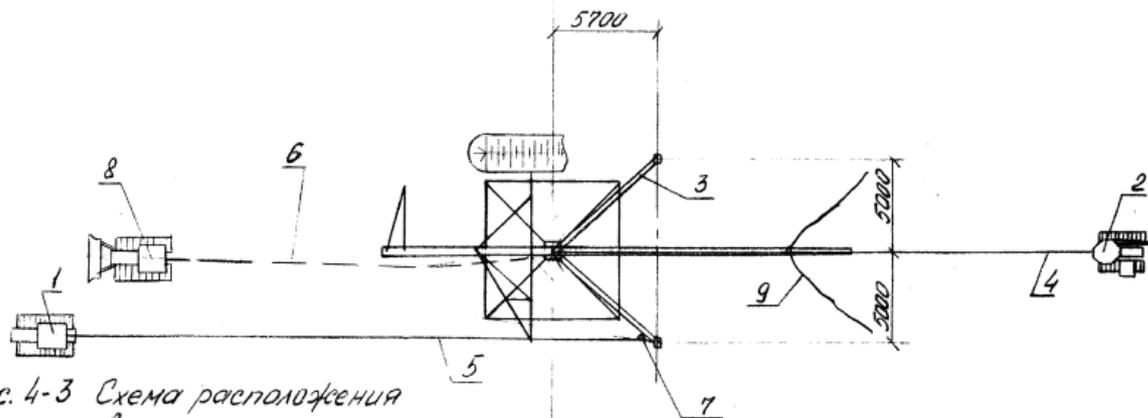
Схема расположения механизмов и такелажа при установке опоры (вид сверху).
